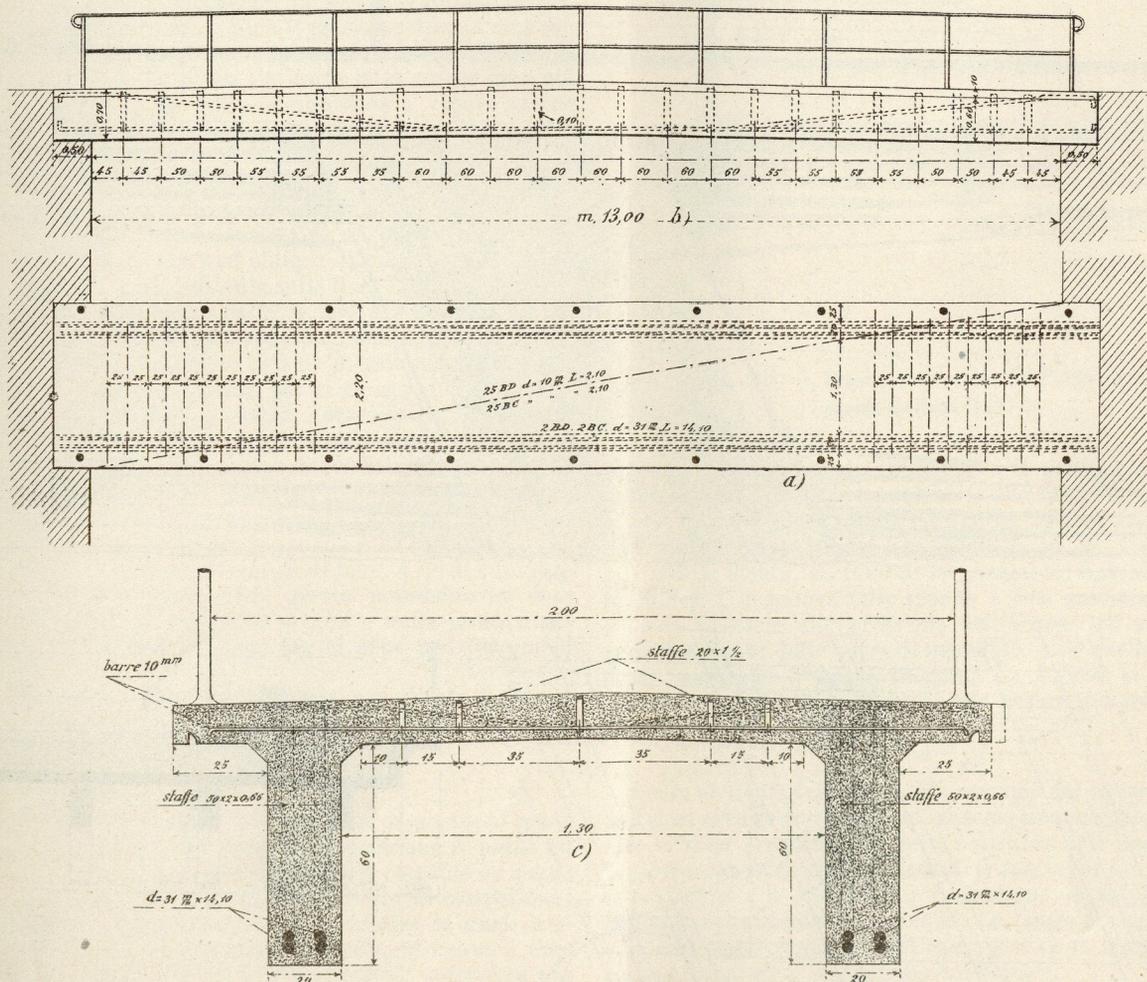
Passerella di Yverdon. — Elevazione, pianta e sezione trasversale.
